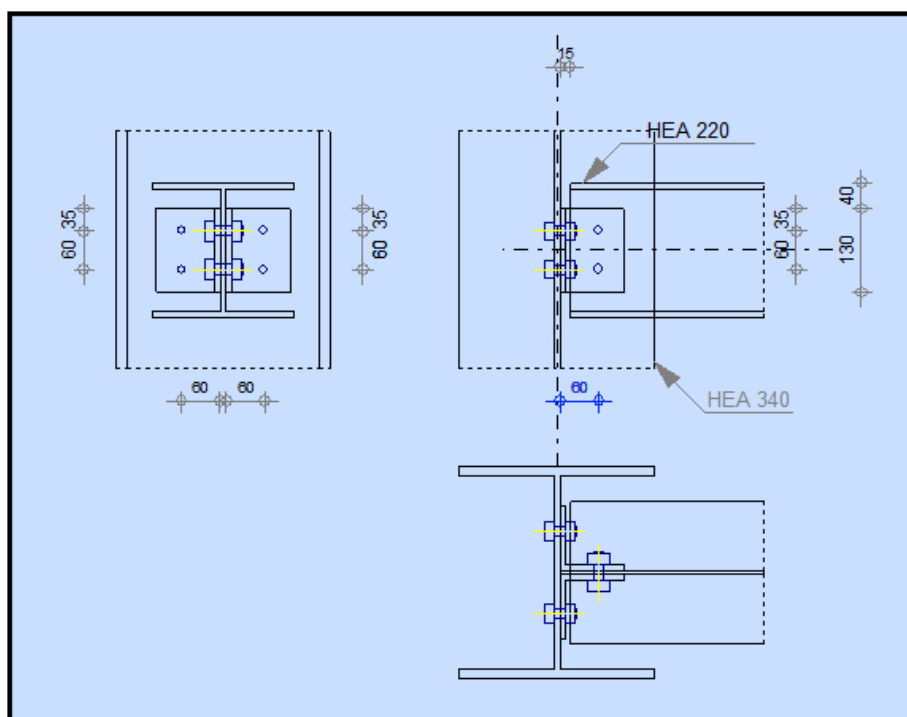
Vue en plan de l'assemblage poteau-sablière.
